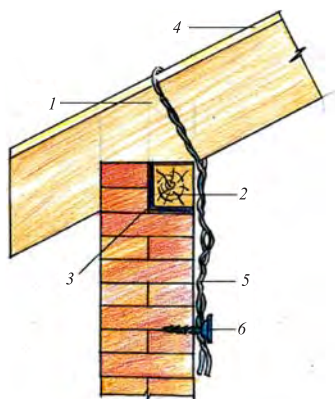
Крепление стропильной ноги: 1 — стропильная нога; 2 — мауэрлат; 3 — гидроизоляция; 4 — обрешетка; 5 — скрутка из проволоки для крепления стропильной ноги к кирпичной стене; 6 — костыль или закладной элемент
